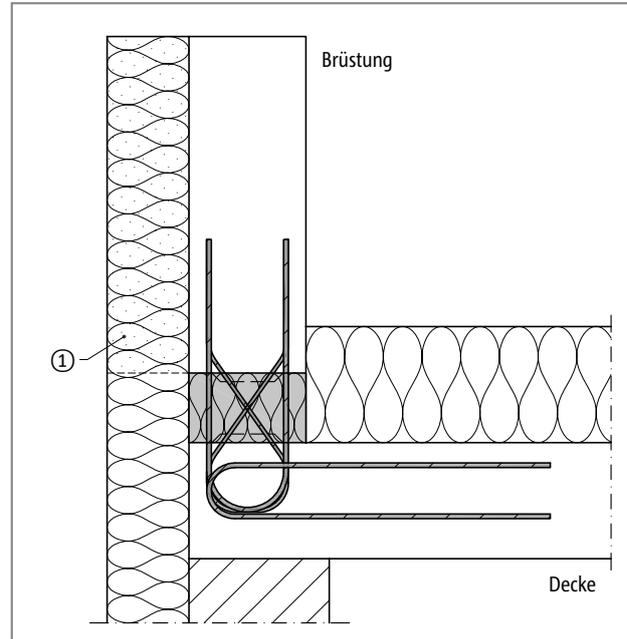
Schöck Isokorb® XT Typ A: Anschluss einer Brüstung (Typ A-MM2-VV1)
